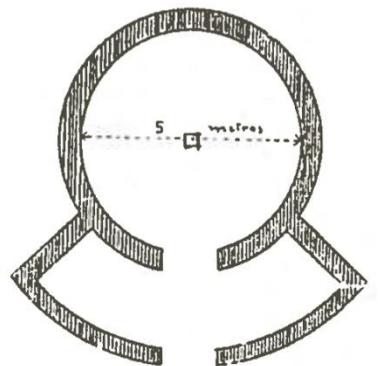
Habitação *citanense* de planta circular com vestíbulo (Planta)
